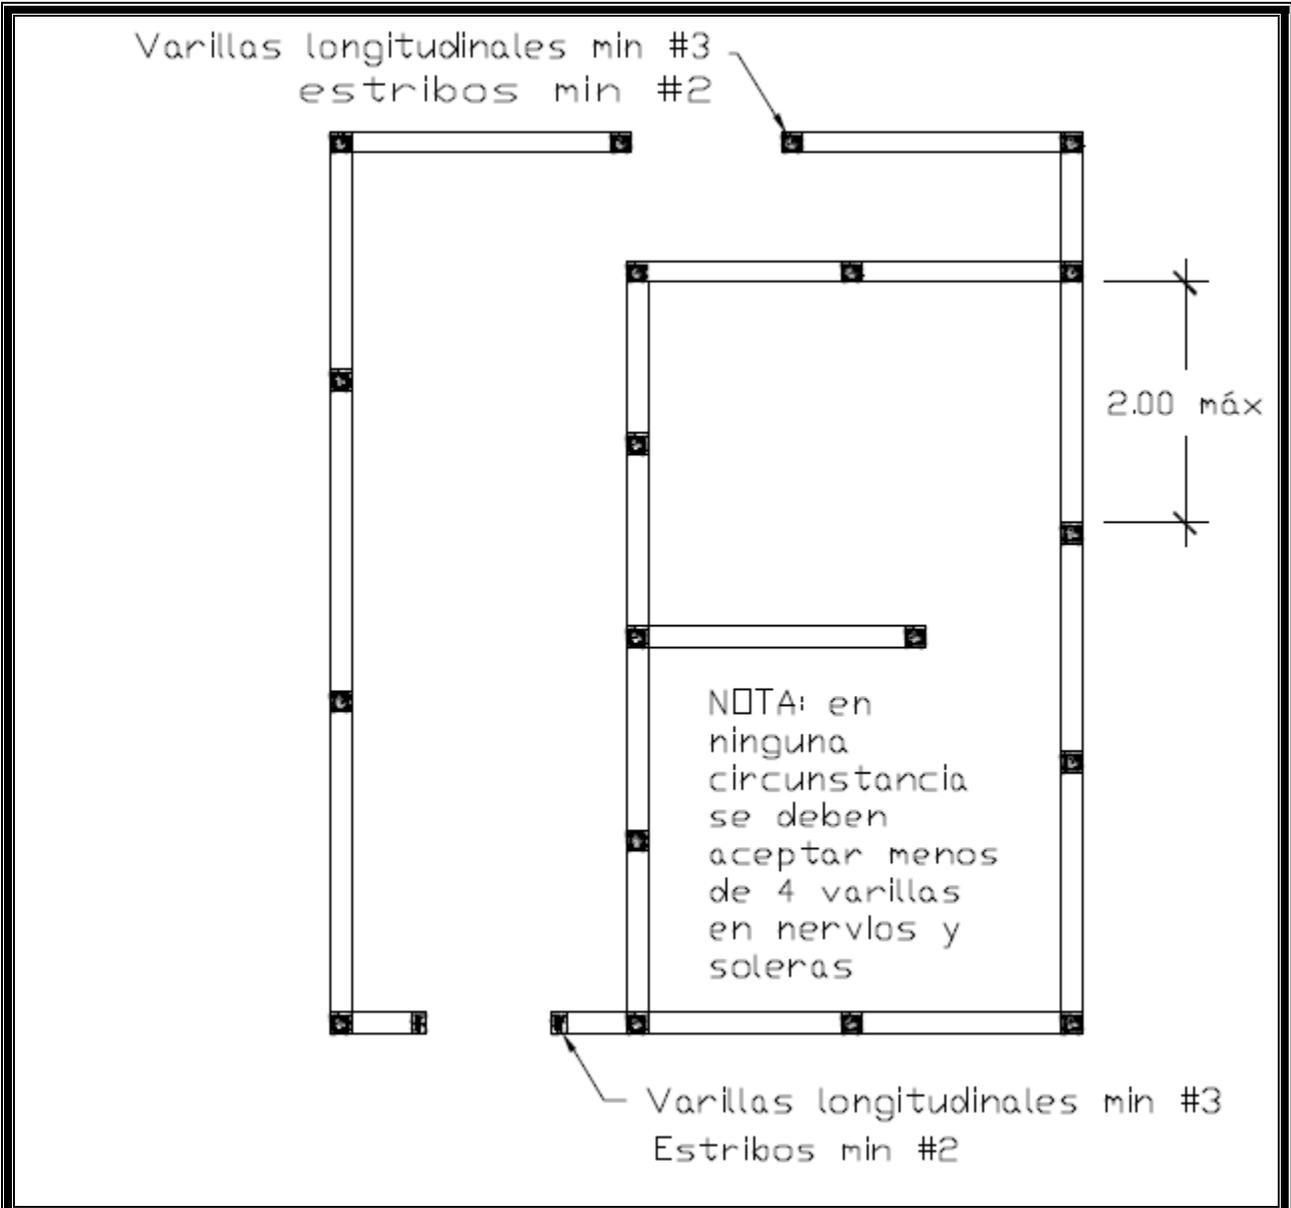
1: Disposición en planta de nervios y alacranes en paredes de ladrillo de barro
